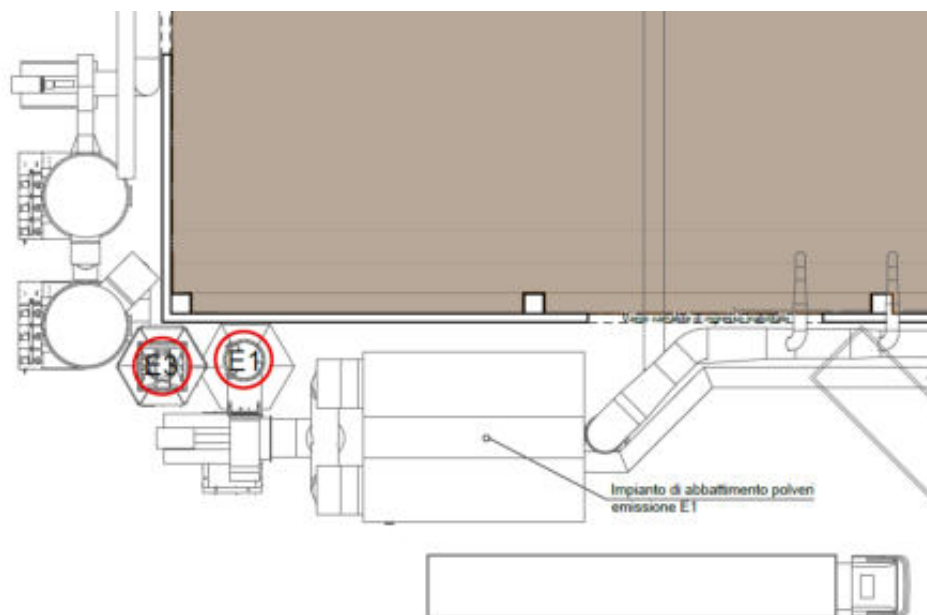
Stralcio planimetrico con l'individuazione della posizione dei sistemi di abbattimento (stato di modifica)
